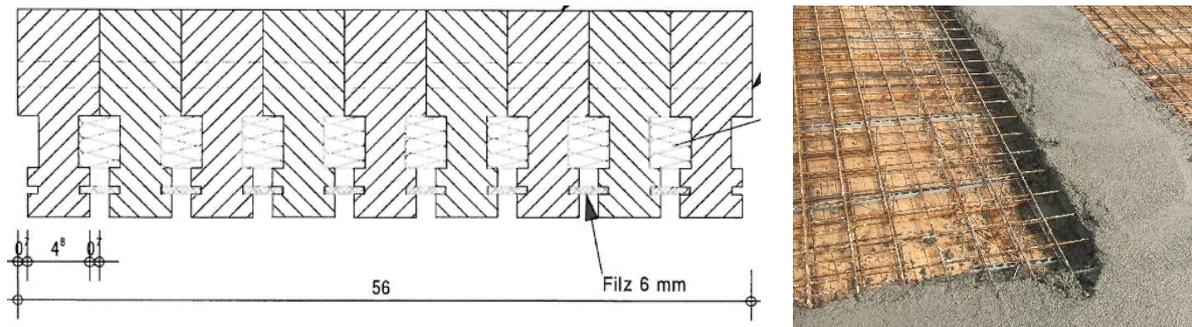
Querschnitt Brettstapelelement mit integrierter Akustik und Betonierung vor Ort mit Normalbeton unterhalb der Wände
